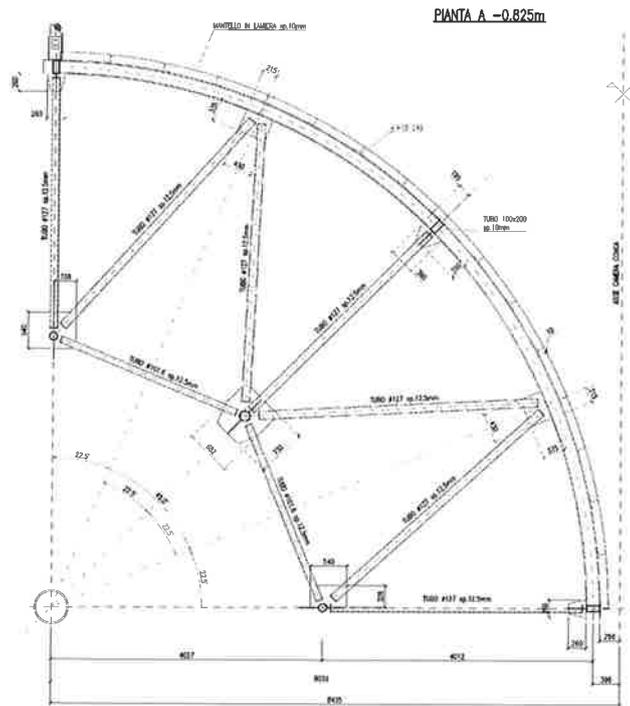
PIANTA TELAIO SPAZIALE A QUOTA - 0.825 M
